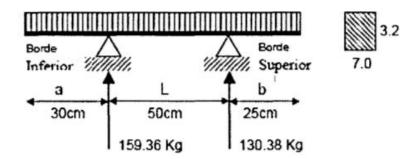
MODELACION DE LAS VIGAS CON LAS CERCHAS
